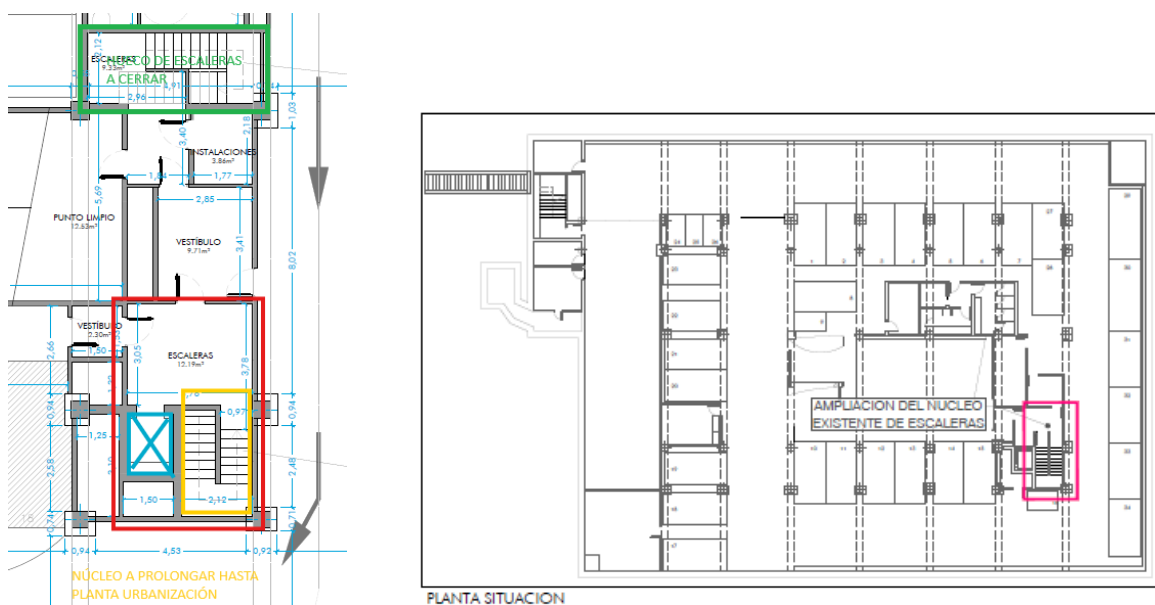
Núcleos de escaleras existentes actualmente y núcleo a ampliar – Vista en planta
